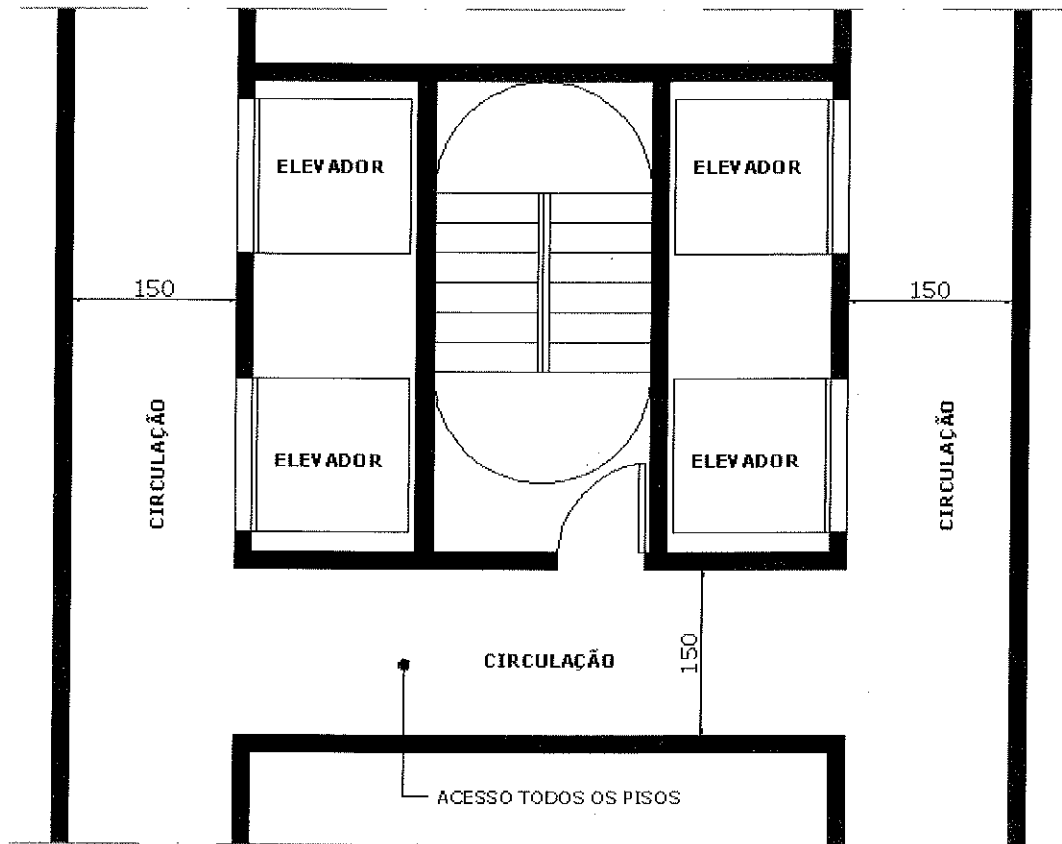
Detalhe elevadores - áreas de acesso interligadas
